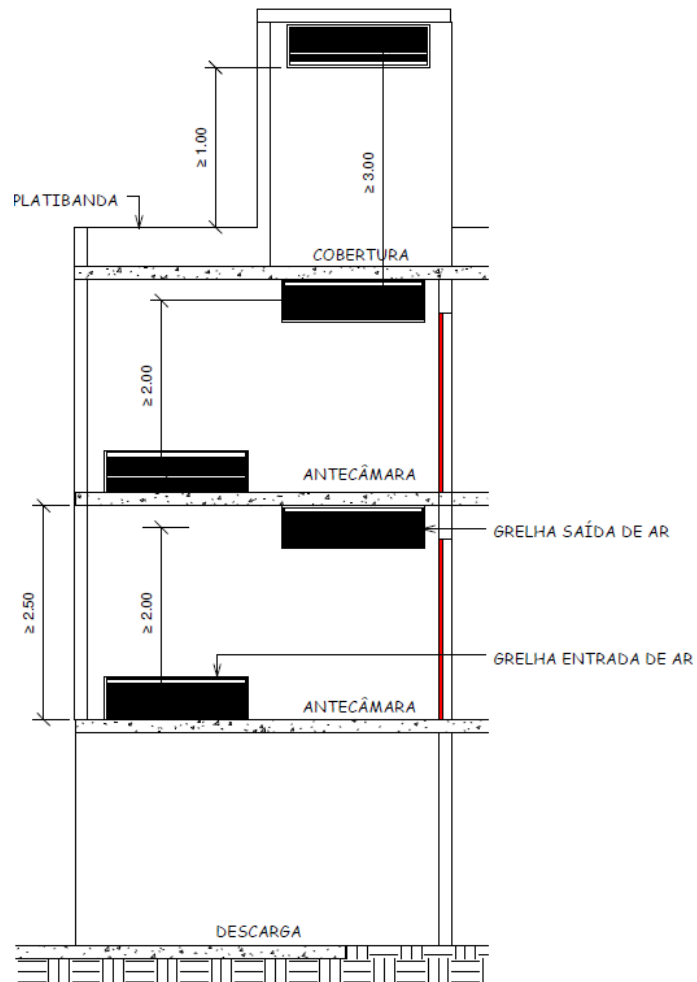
C - Escada à prova de fumaça (corte da antecâmara).
